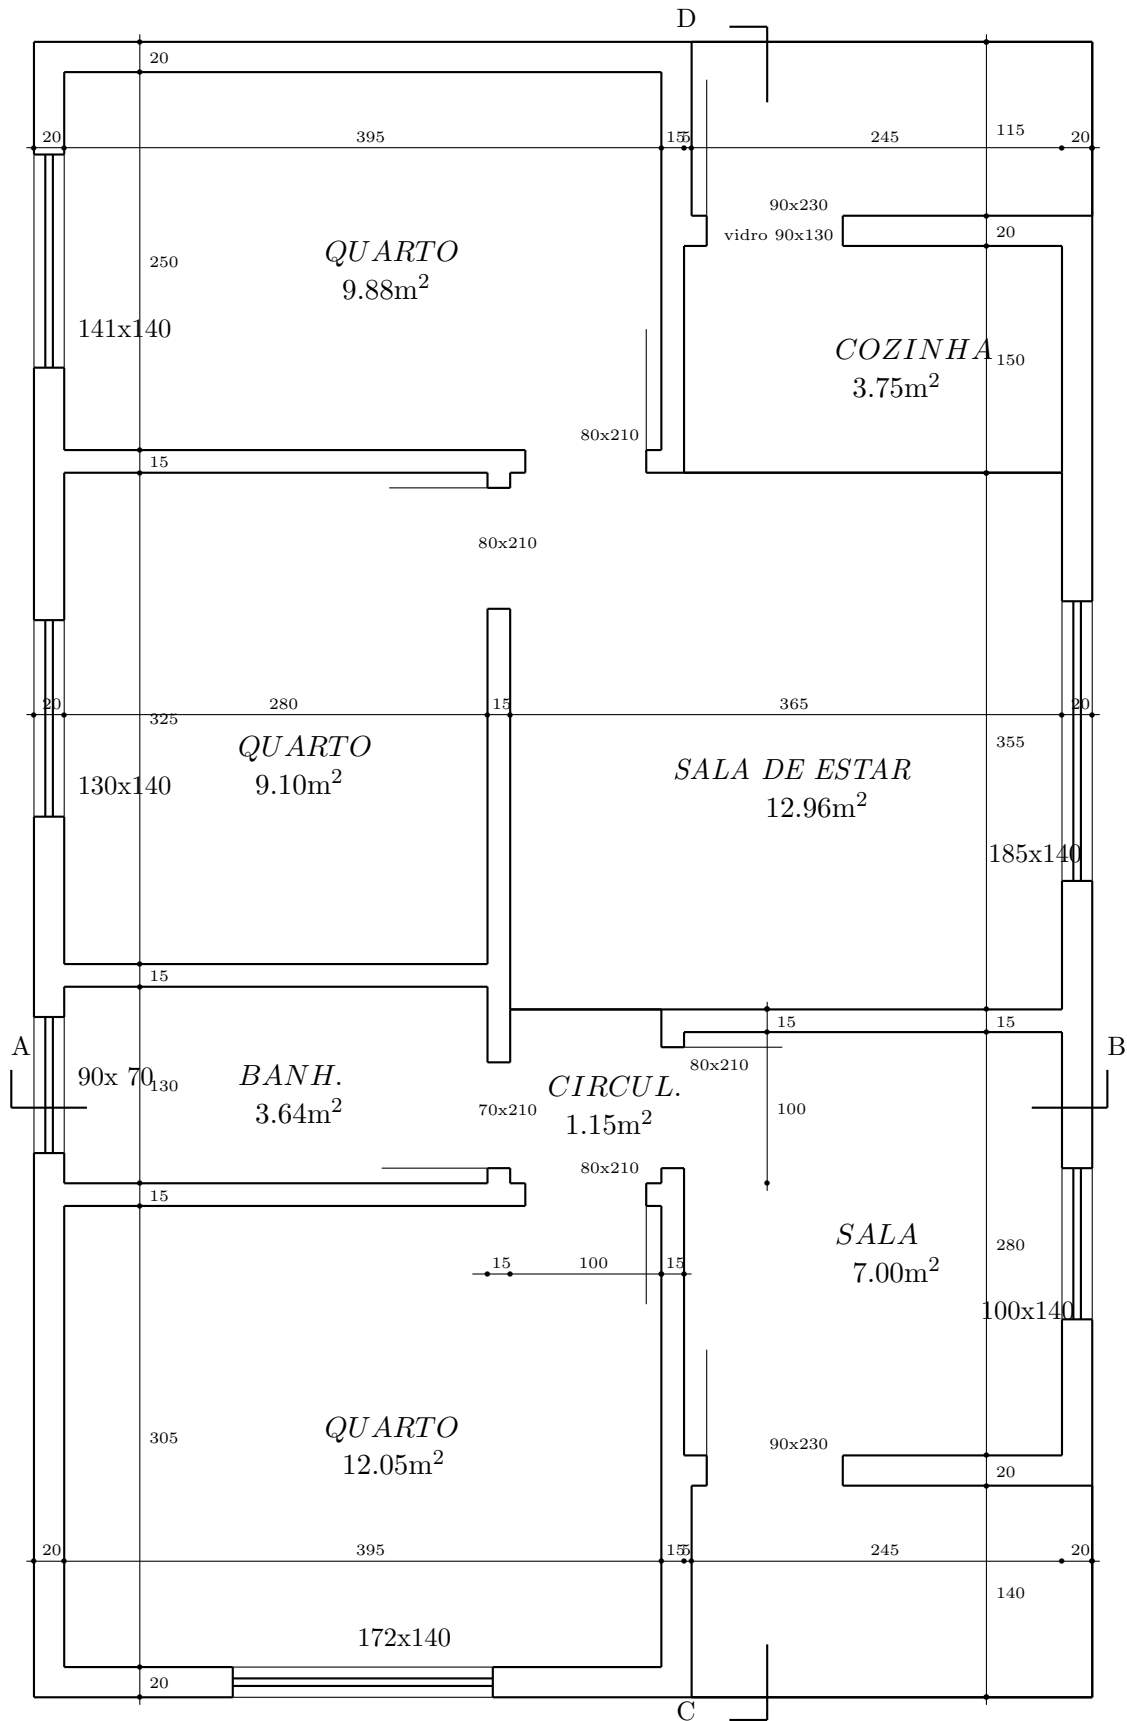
Planta Baixa - prop. Sr. João da Silva, Área total: 69.89m², Esc 1:50.
